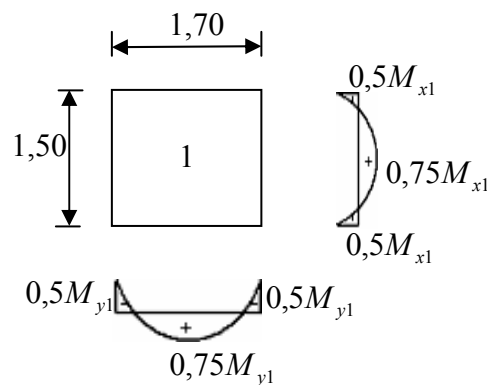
dimensions de panneau de dalle d'ascenseur.
